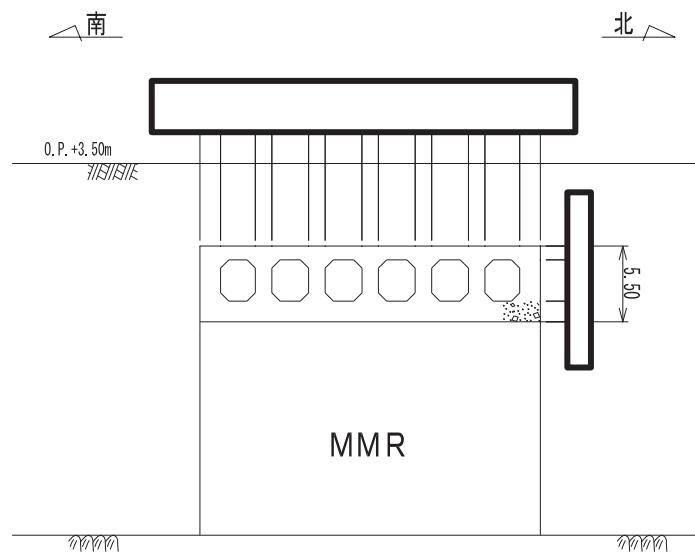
取水口断面図（B-B断面図、漸縮部）
